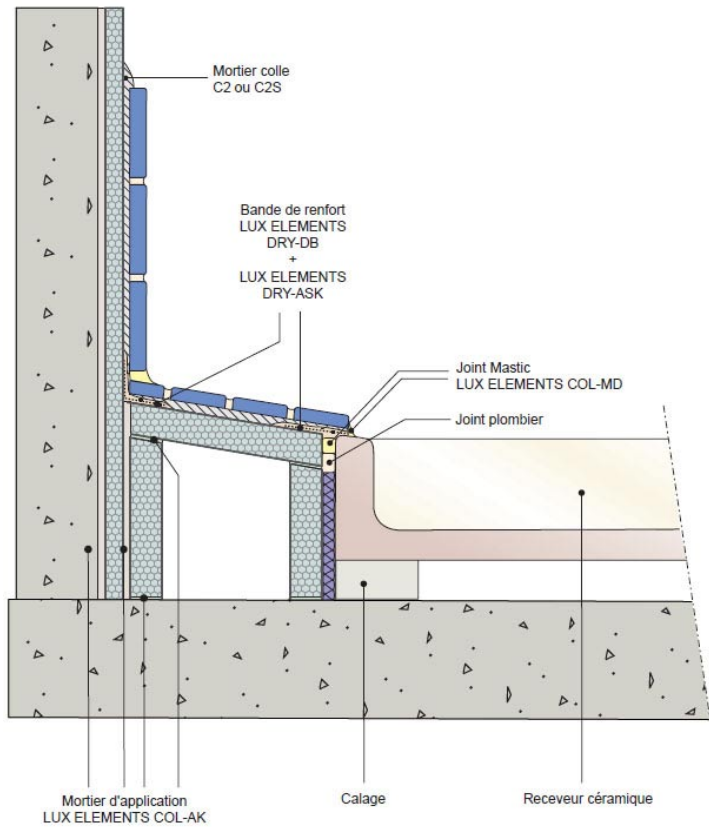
Exemple de raccordement à un appareil sanitaire.
